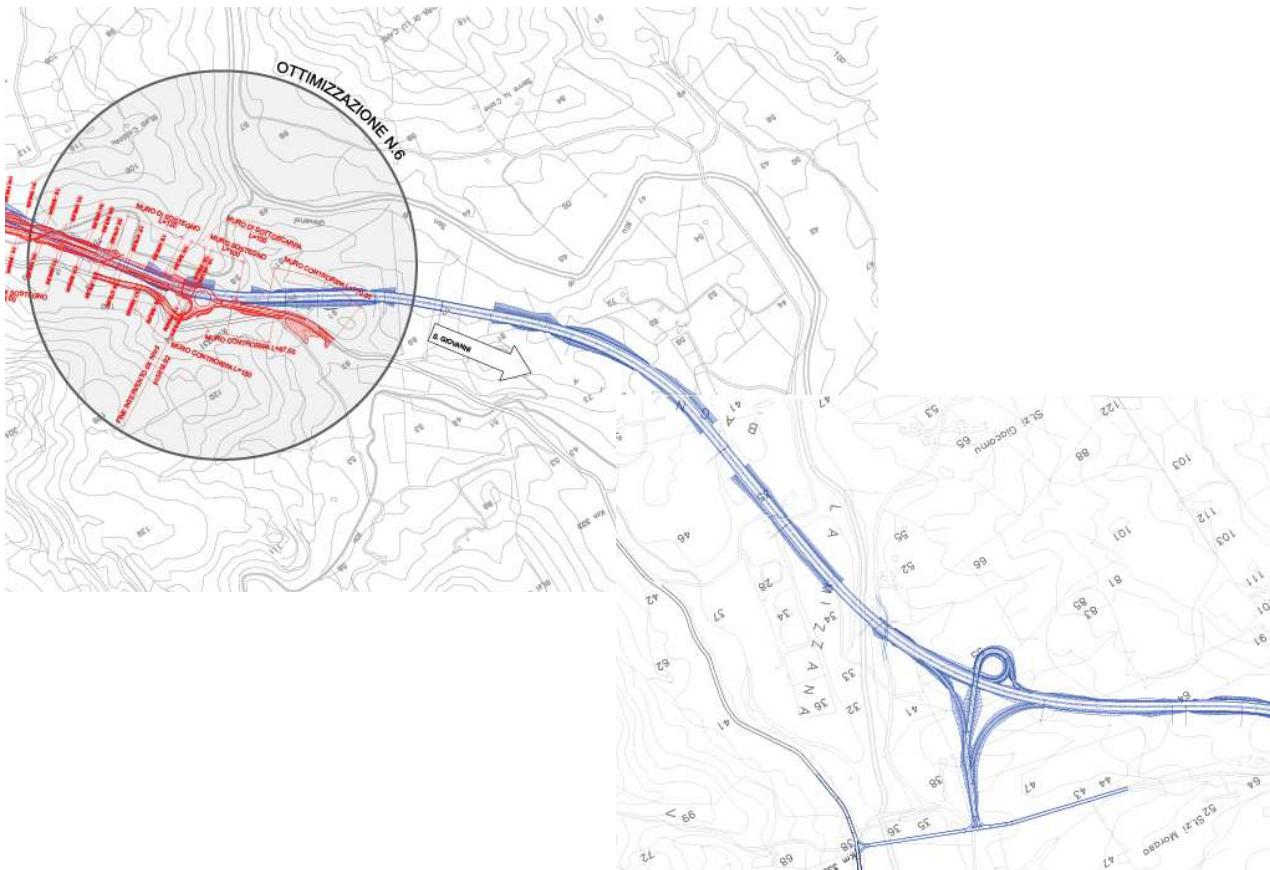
Stralcio sovrapposizione tracciati – Tratto finale
